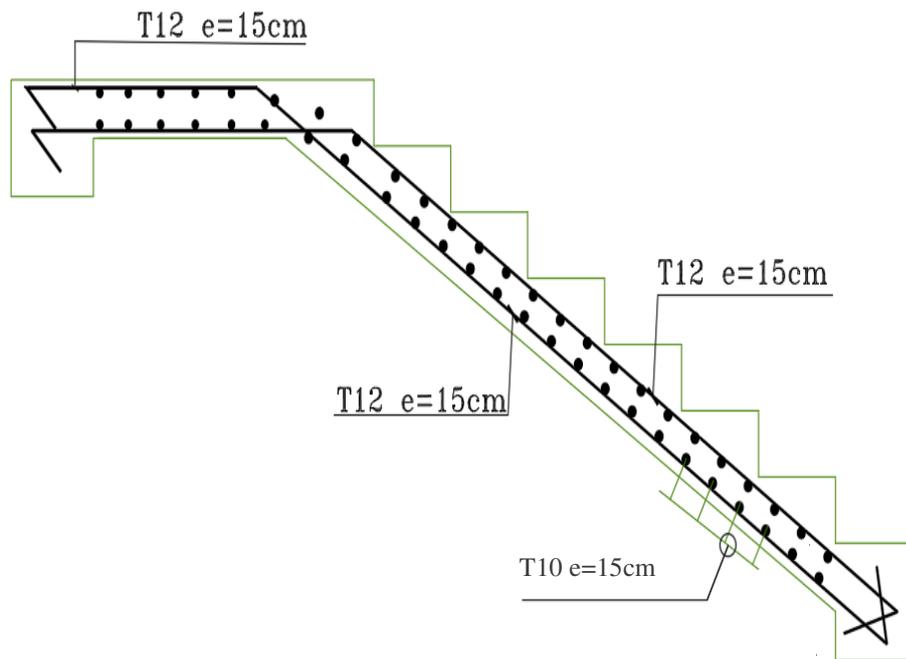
Dessin de ferrailage d'escaliers.
